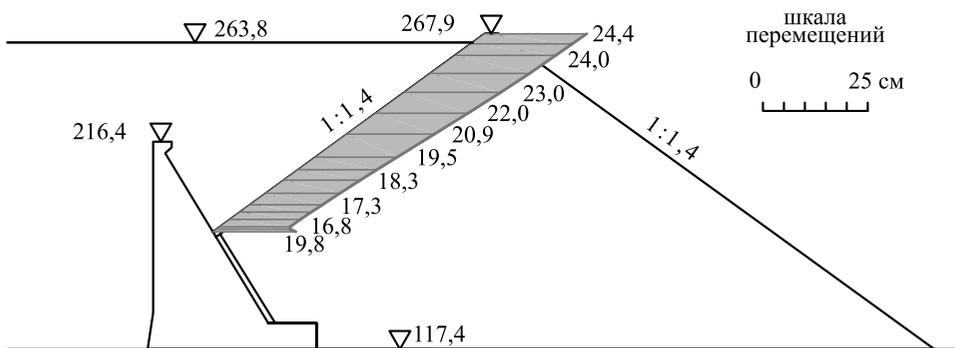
Горизонтальные смещения (см) железобетонного экрана
